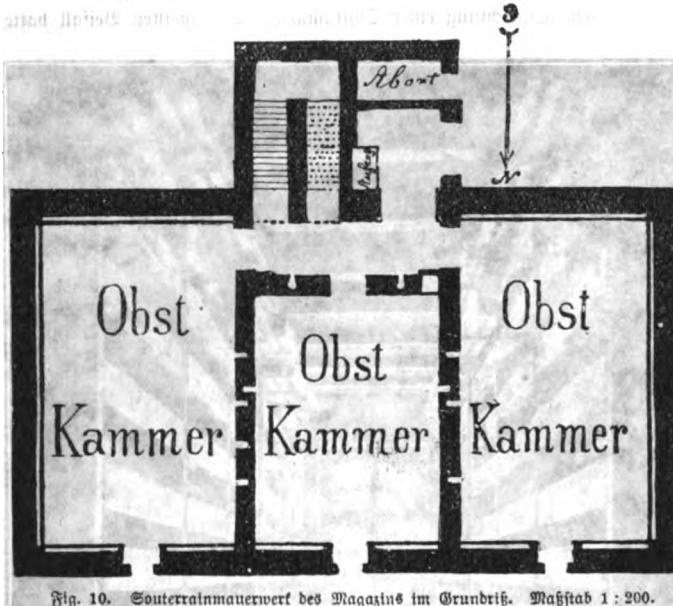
Souterrainmauerwerk des Magazins im Grundriß. Maßstab 1 : 200.
